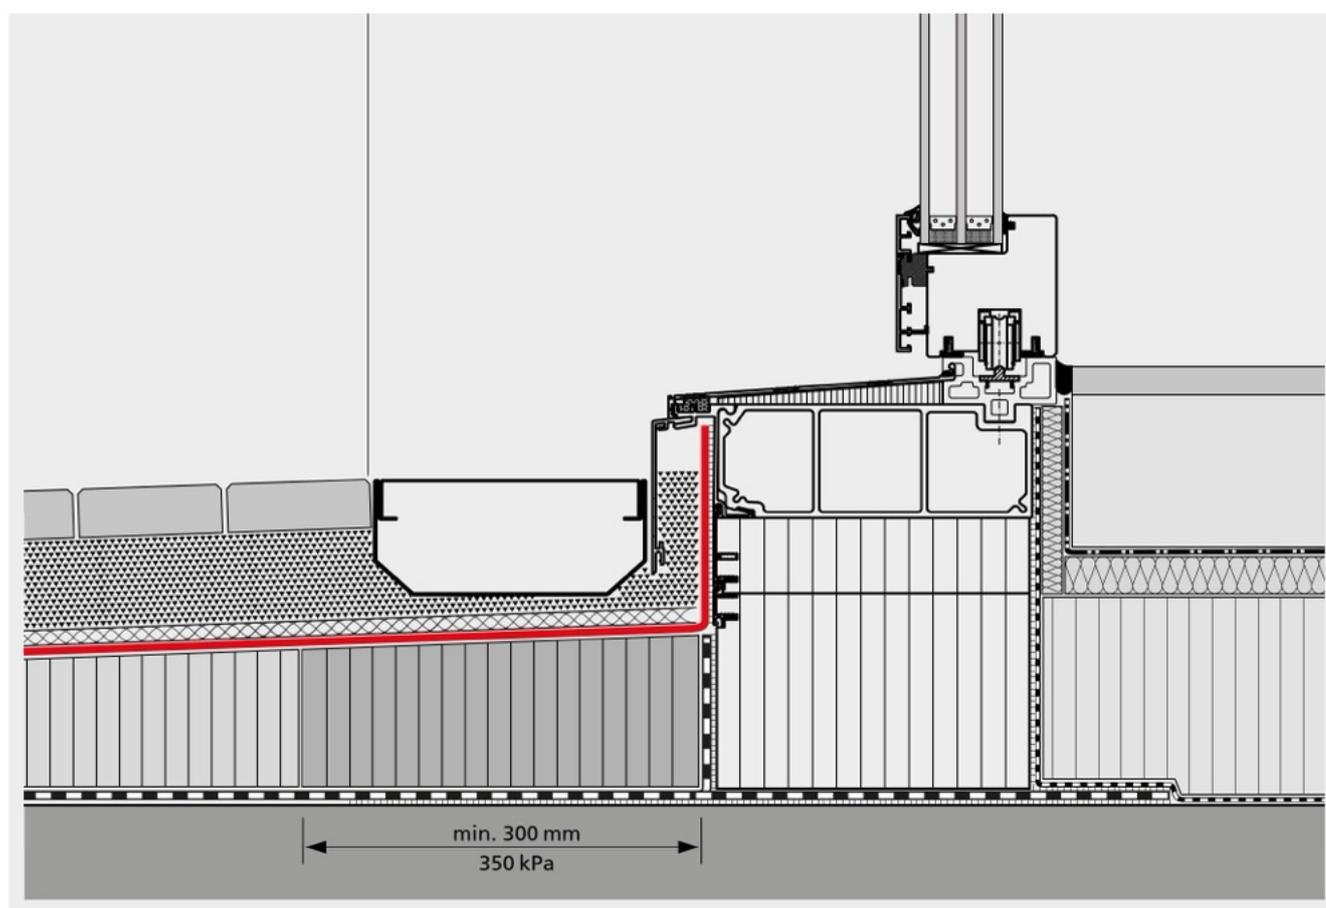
Caniveau devant le seuil sur couche d'usure à joints fermés.
